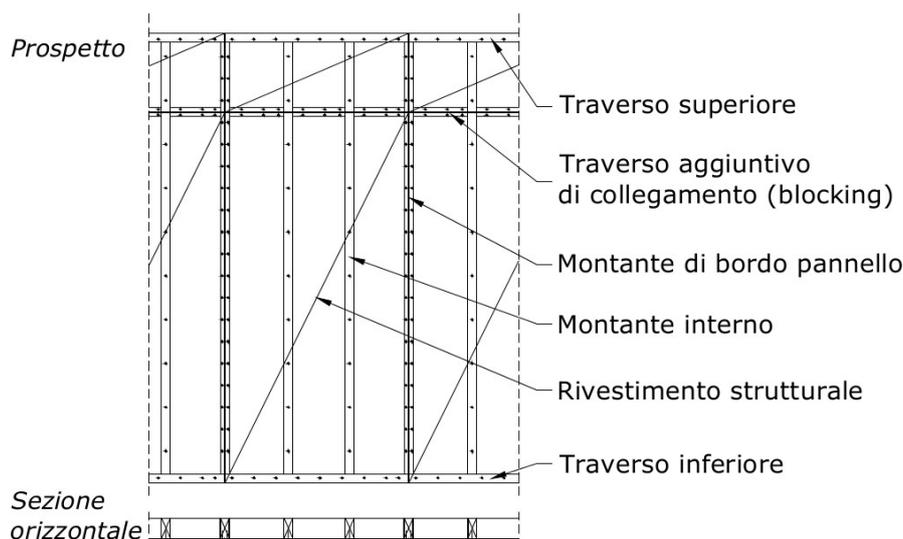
Parete Platform-Frame, prospetto e sezione orizzontale.
